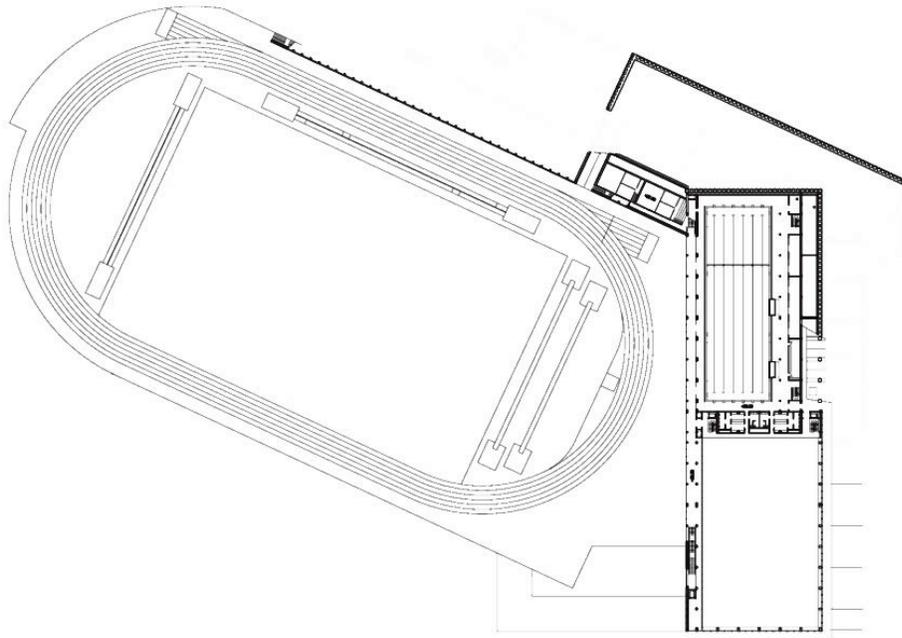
Planimetría en planta del CAR de Sierra Nevada. [12]
